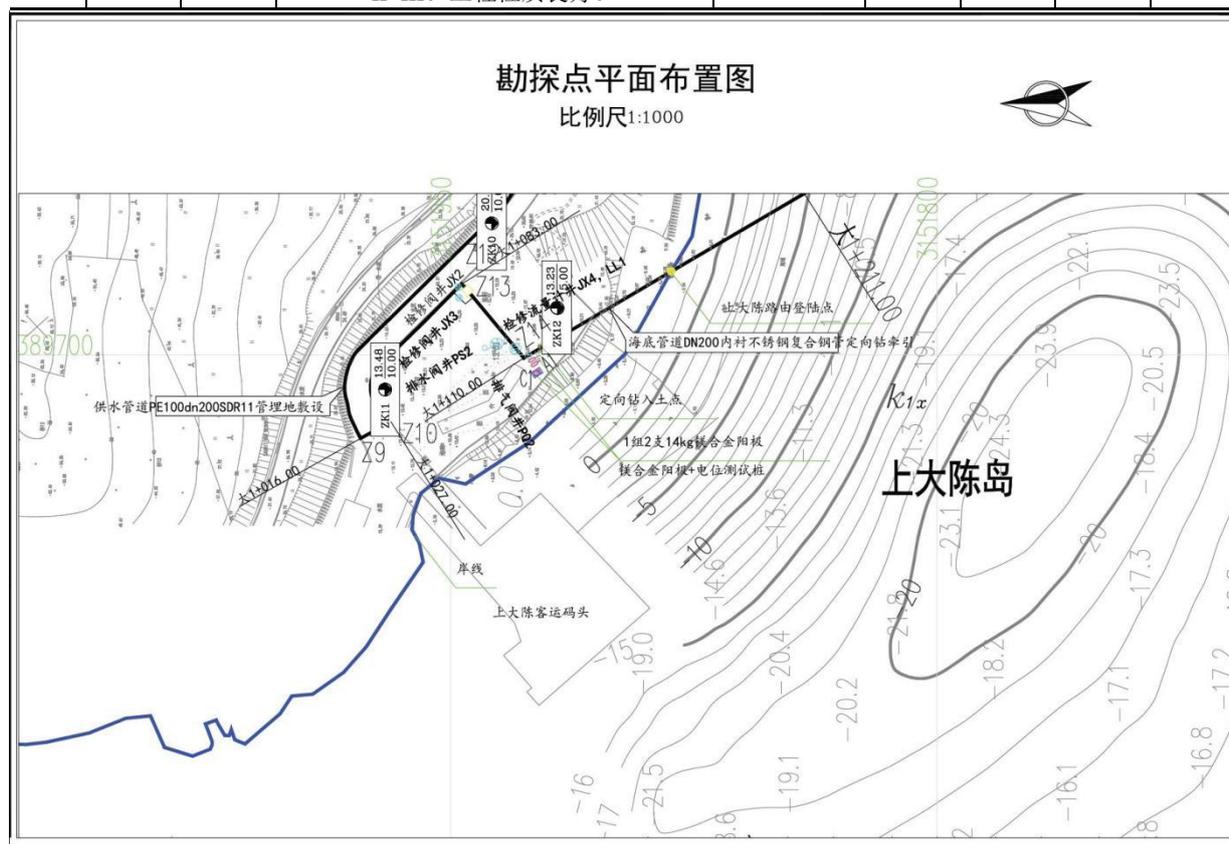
上大陈登陆点附近勘探点平面布置图
